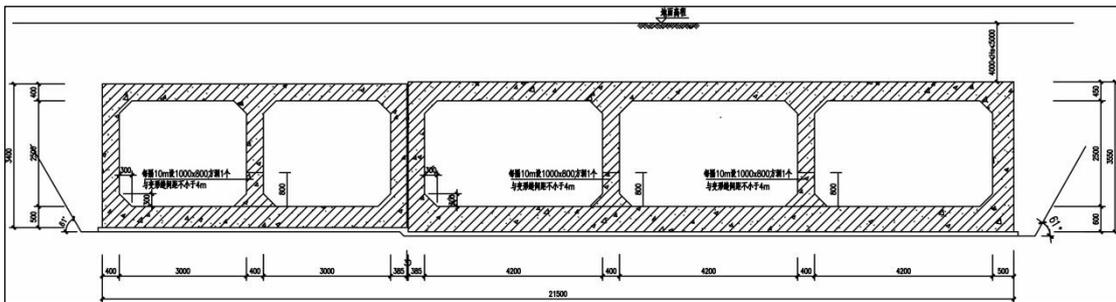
高低排水区暗涵并行段雨水方沟断面示意图
